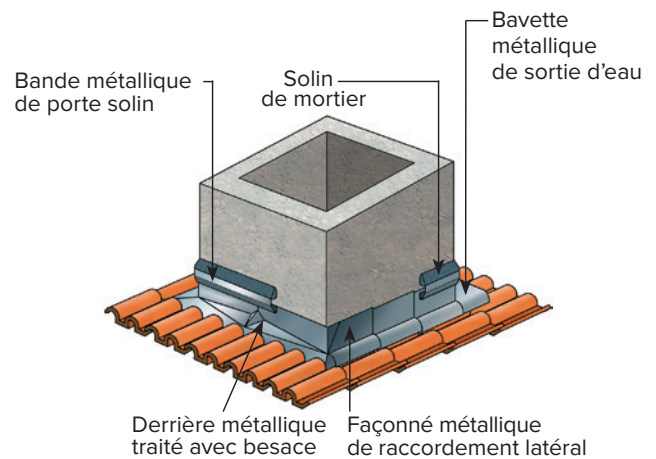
Souche de cheminée sur tuiles profilées en béton (ou à emboîtement à relief en terre cuite) avec derrière traité en besace
